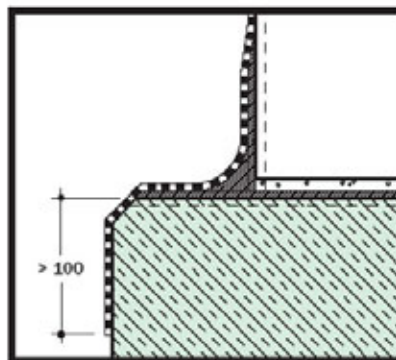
/7: Anschluss einer einkomponentigen KMB-Abdichtung am Bodenplattenabsatz, Querschnittsabdichtung und Untergrundvorbehandlung mit Dichtschlämme.
